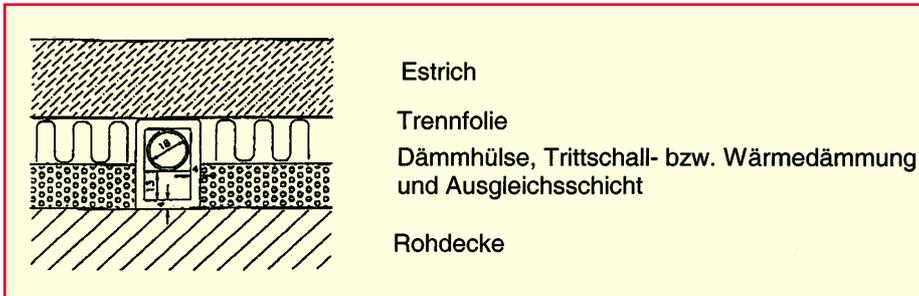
Schematischer Deckenaufbau der Geschoßdecke mit Radiatorheizung (im LV nicht enthalten: Estrich, Trennfolie, Trittschalldämmung, Ausgleichsschicht)
